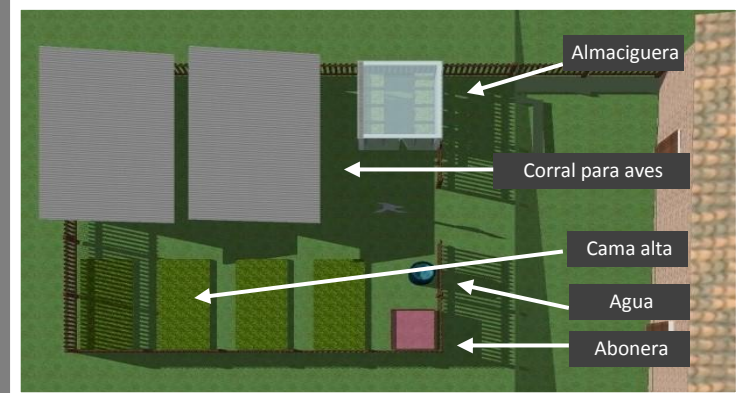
Planta de área de confinamiento para la crianza de aves.
